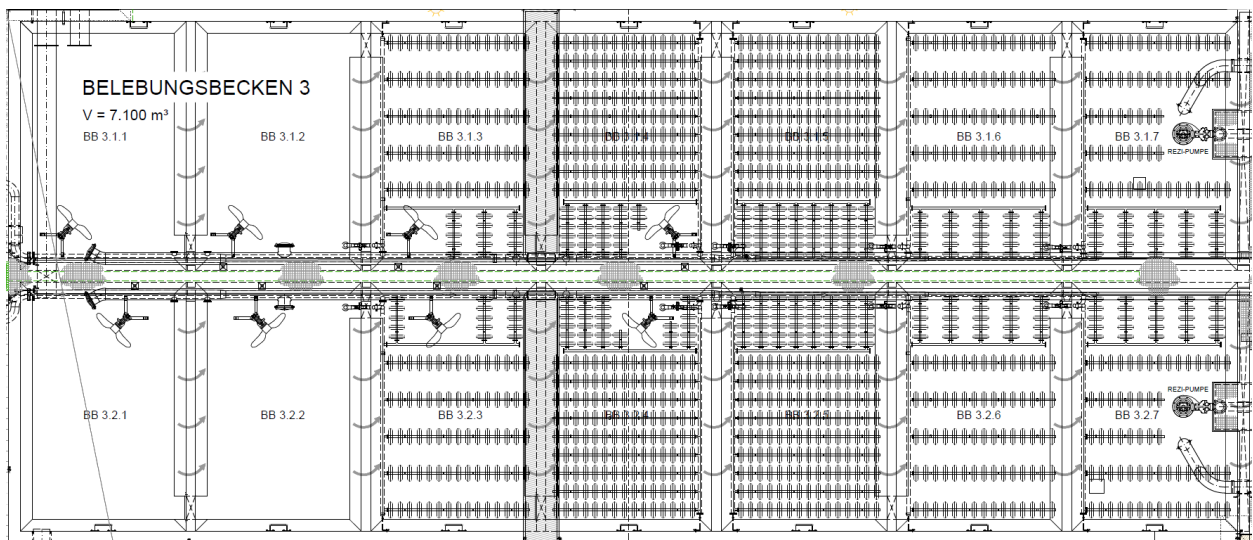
Draufsicht Belebungsbecken mit technischer Ausrüstung
